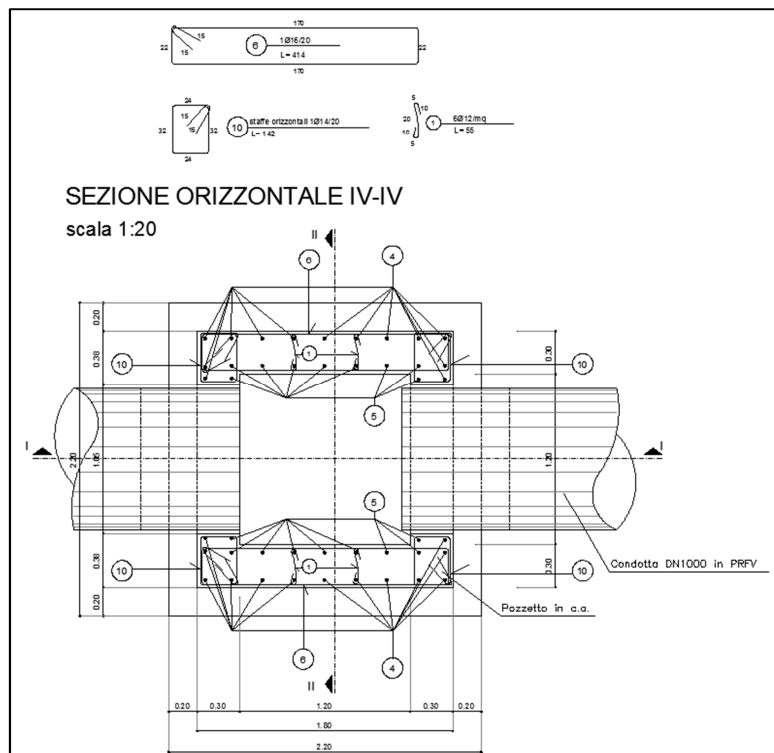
SCHEMA ARMATURA SEZIONE IV-IV
